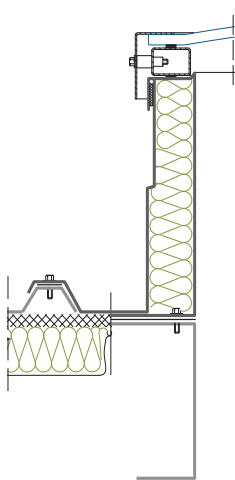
Przekrój podłużny przez kłapę mcr PROLIGHT typ E z podstawą PR do dachów profilowanych wzdłuż spadku dachu
